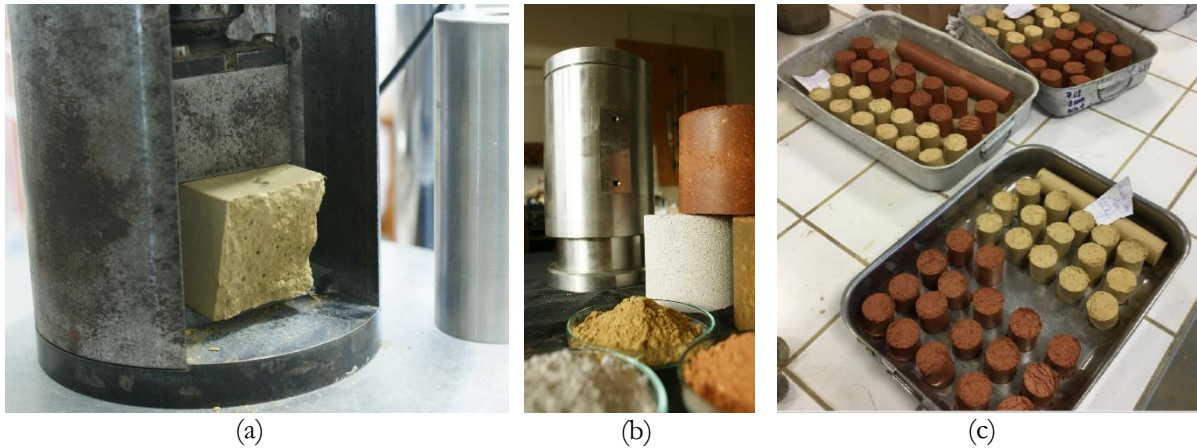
Différentes formes d'éprouvettes étudiées dans cette campagne expérimentale. (a) demi-épreuve moulée  $40*40*160 \text{ mm}^3$ , (b) éprouvettes cylindriques ( $H=70 \text{ mm}$ ,  $D=70 \text{ mm}$ ) compactées ou vibro-compactées, (c) éprouvettes cylindriques extrudées ( $H=35 \text{ mm}$ ,  $D=35 \text{ mm}$ )
